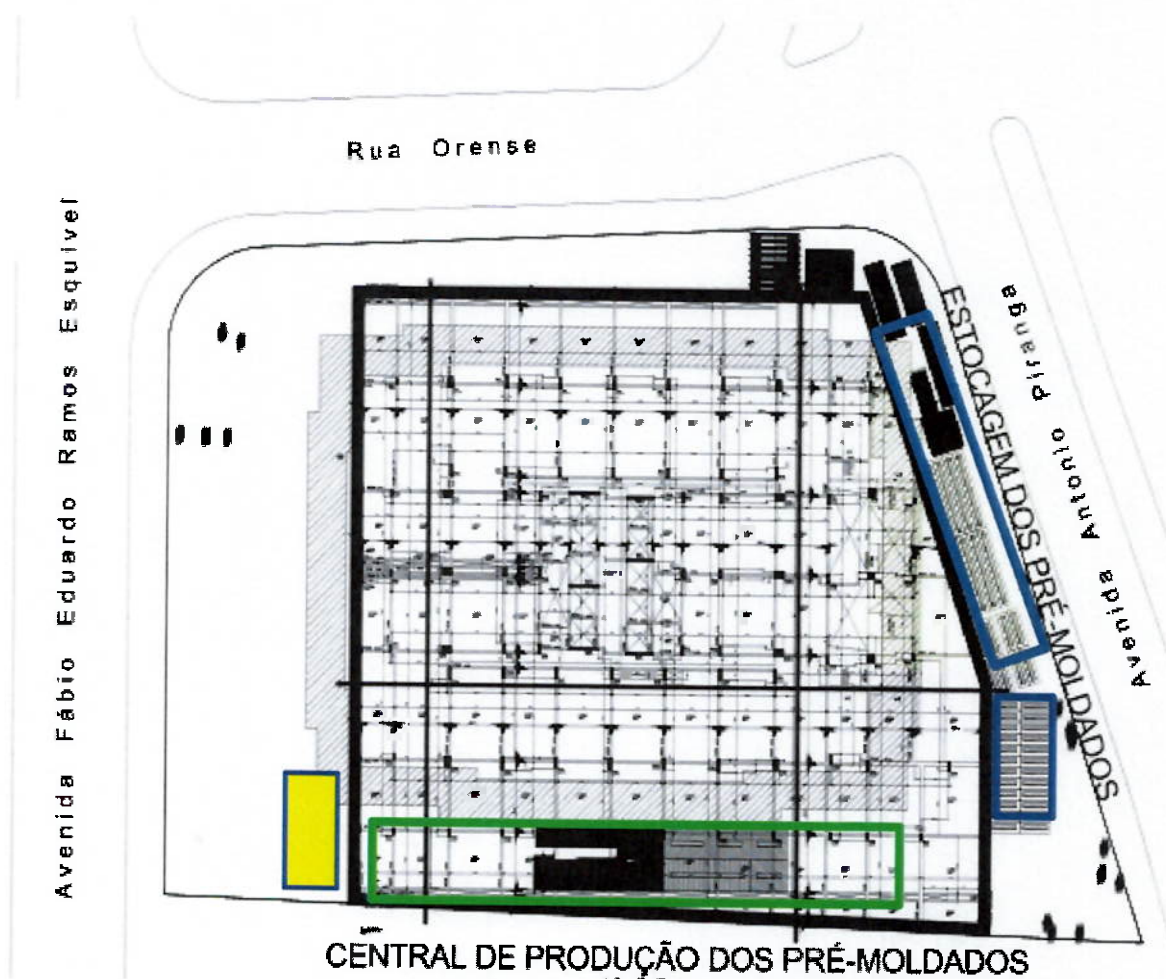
Implantação de canteiro de obra, delimitando as áreas de estocagem, execução e concretagem dos elementos pré-moldados (Fonte: Construtora)
